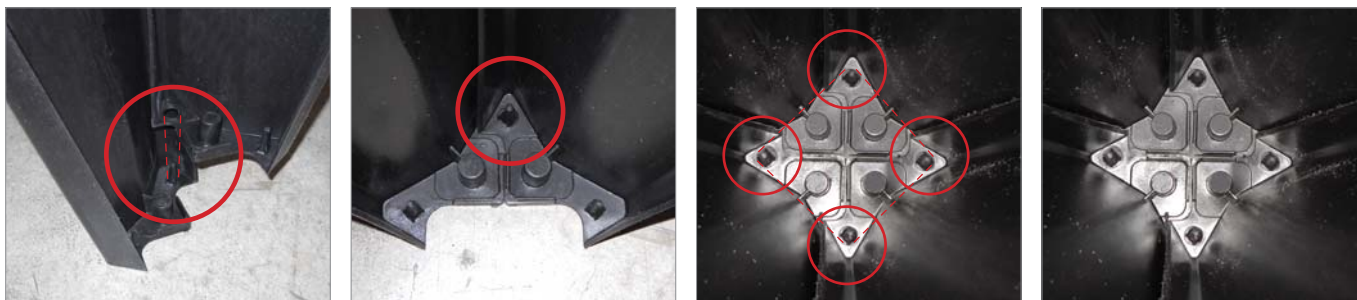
Suche układanie pierwszego szalunku, strzałka skierowana jest w stronę krawędzi fundamentu.
